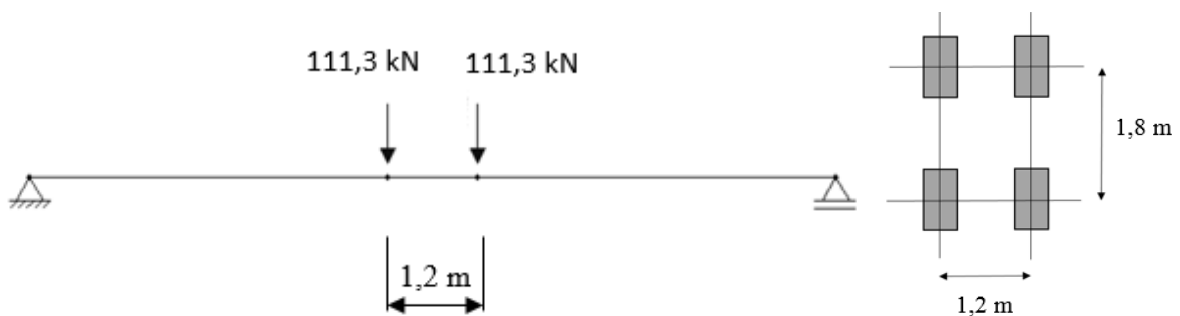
Ilustração da carga Tandem em perfil longitudinal (à esquerda) e em planta (à direita)
